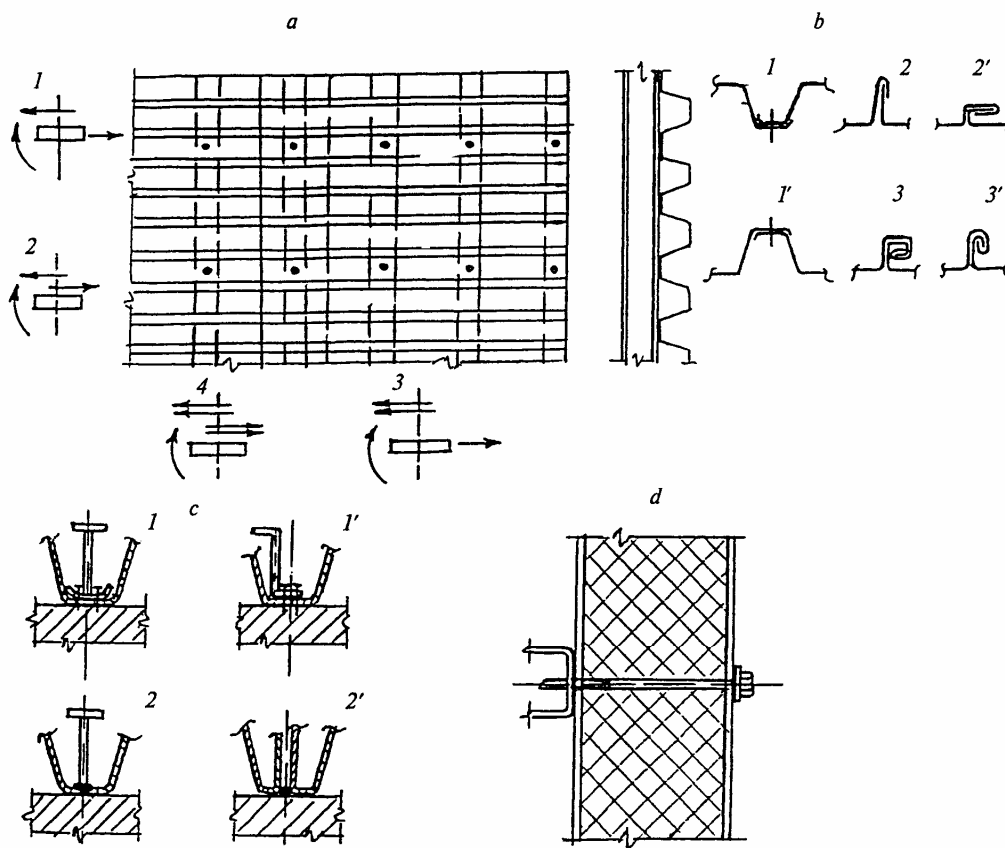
Конструктивні форми СМЗ
